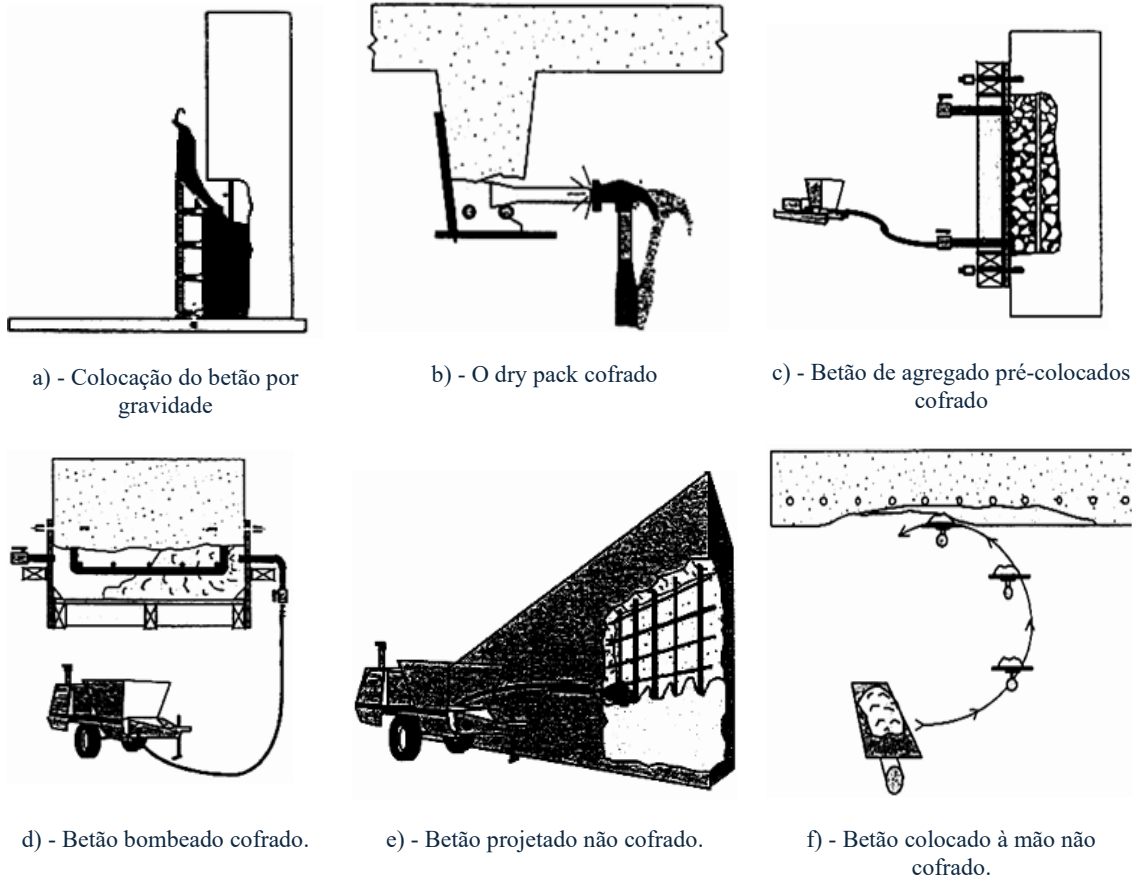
Metodologias de execução de betonagem no reforço de vigas por encamisamento de betão armado (12).
